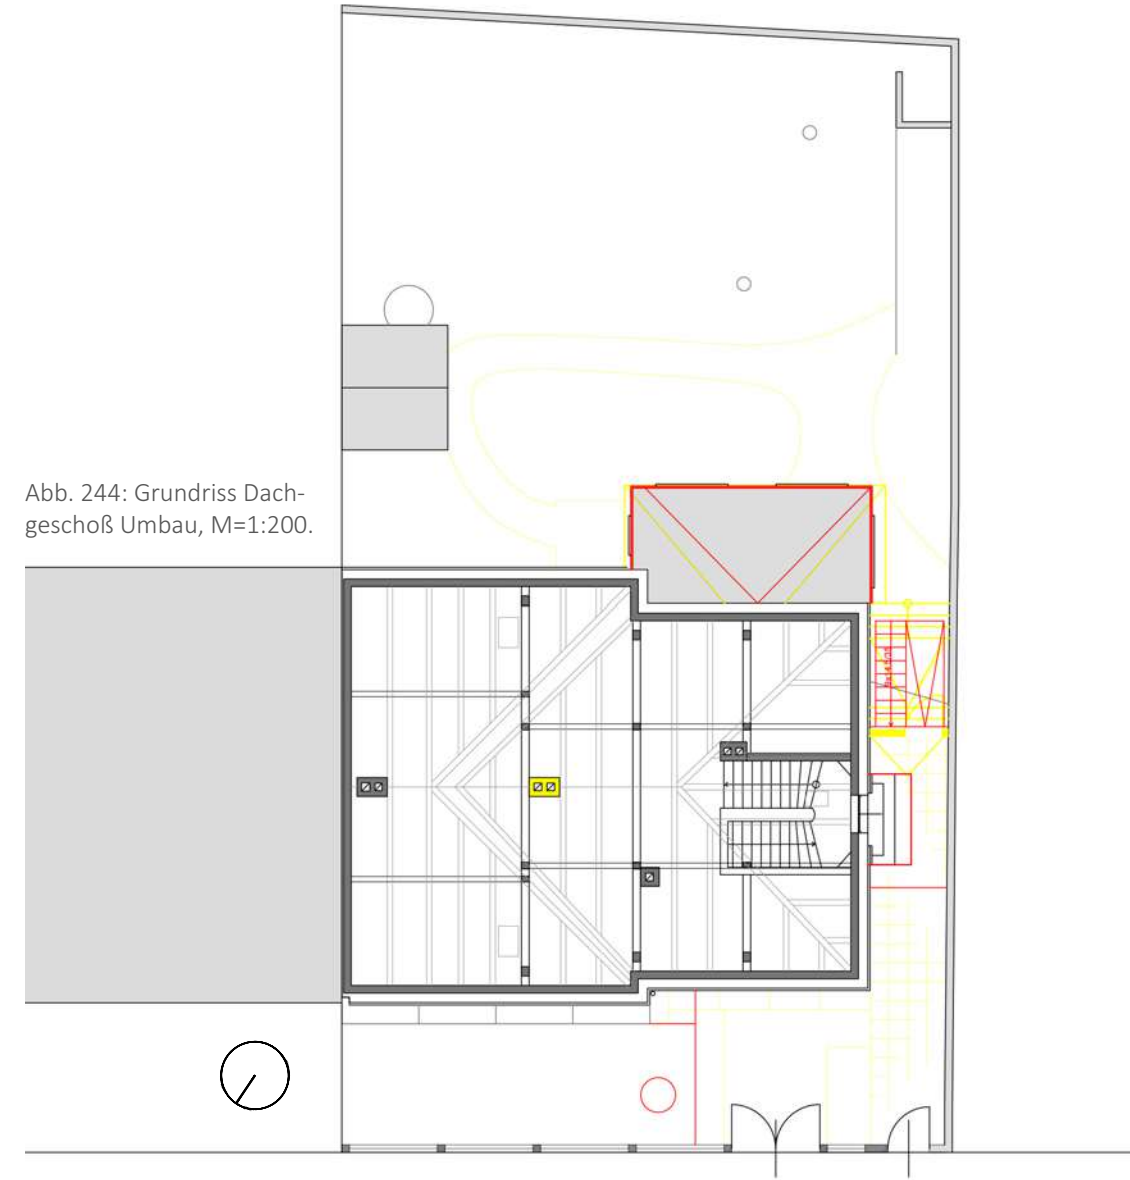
Grundriss Dachgeschoß Umbau, M=1:200.
